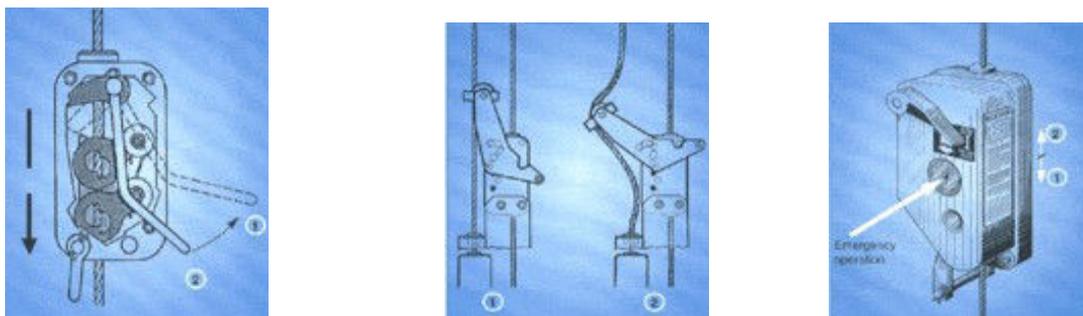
Vista interna das partes constituintes do bloqueador automático
